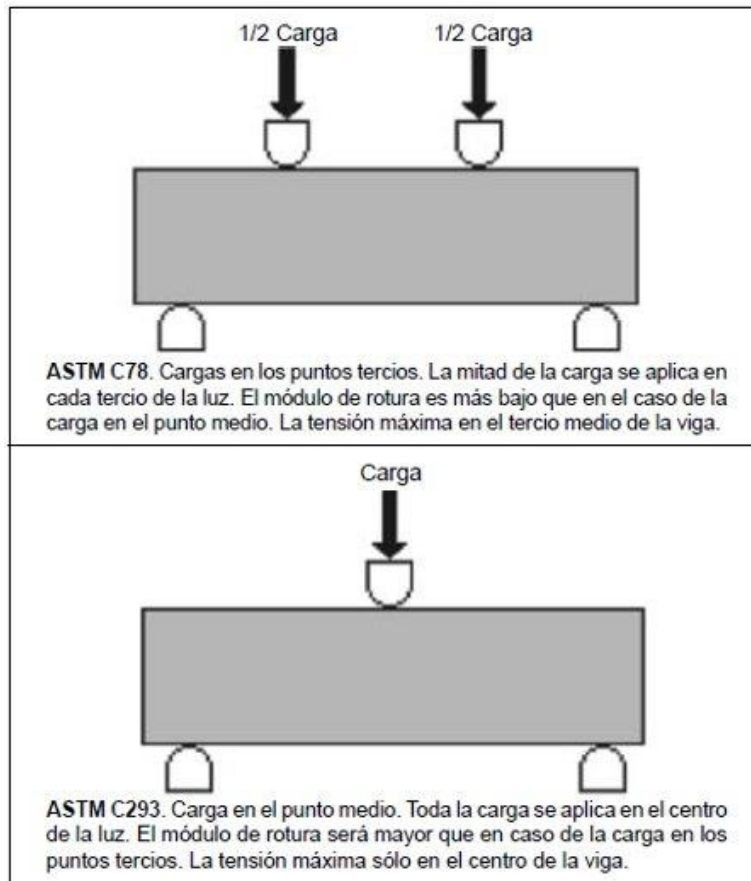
Ensayo de Flexión en vigas de hormigón simple. (CivilGeeks, 2011)
